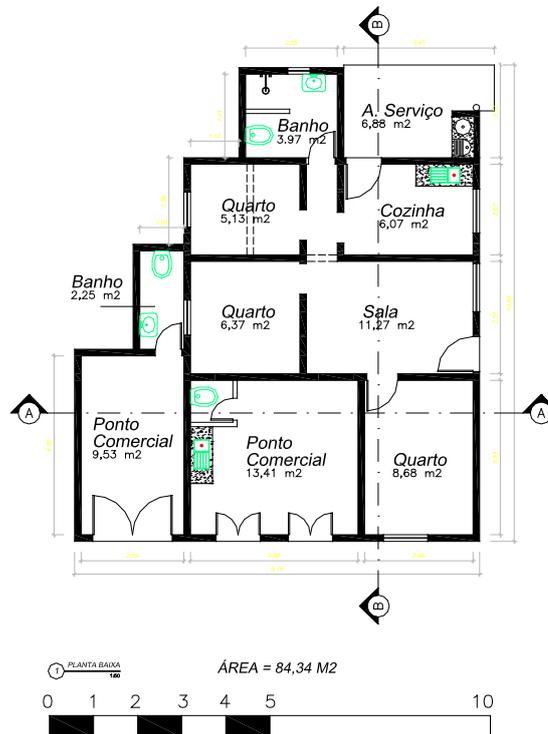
Planta pavimento térreo - Casa João Batista Félix
